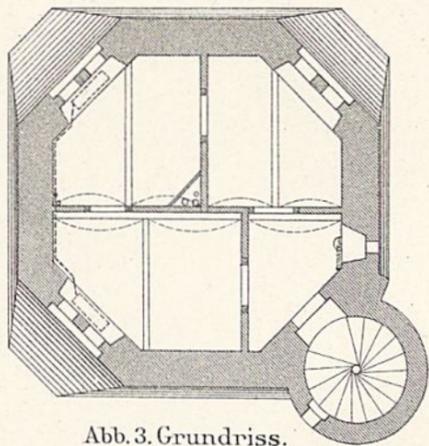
Grundriss des Wasserthurms im Erdgeschoss.
